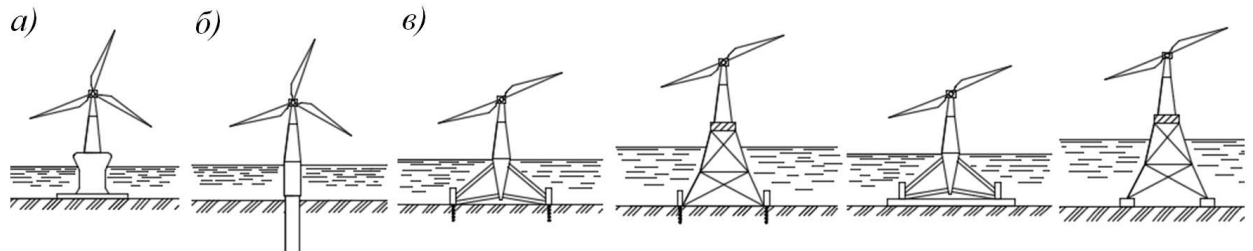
Некоторые типы фундаментов под ВЭУ: а) бетонный короб; б) односвайное основание; в) основания в виде треног и ферменных конструкций
